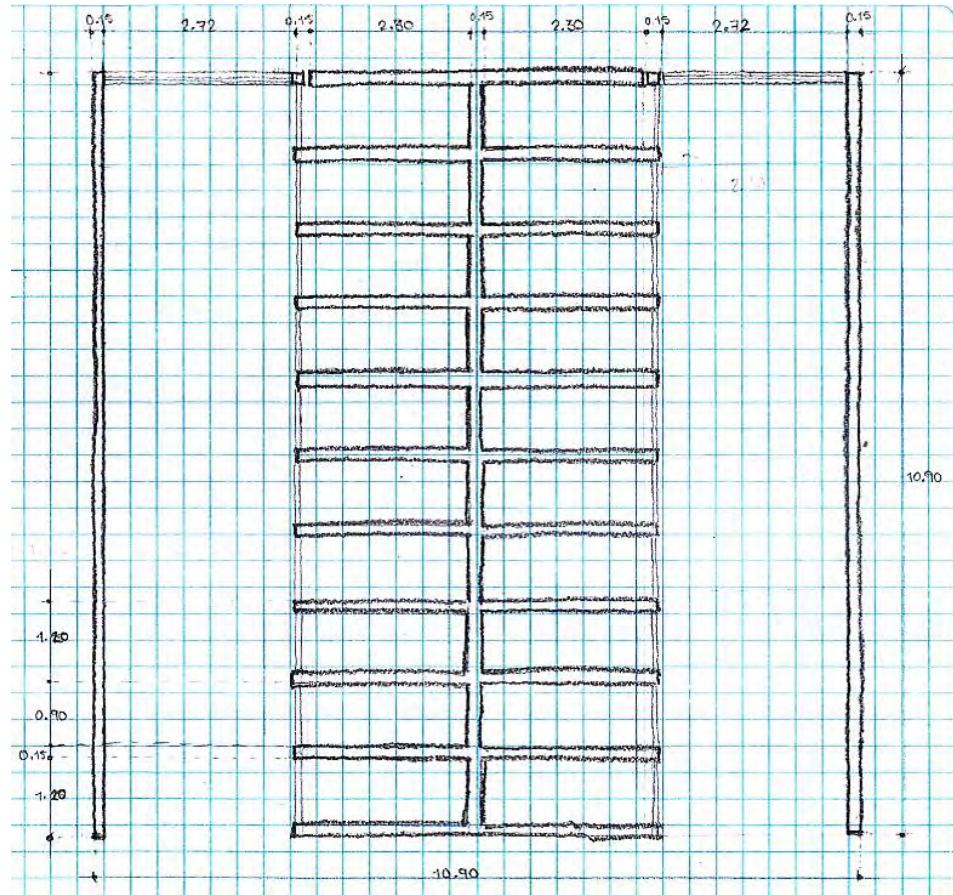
Gavetas con dimensiones en planta (dibujo propio)
